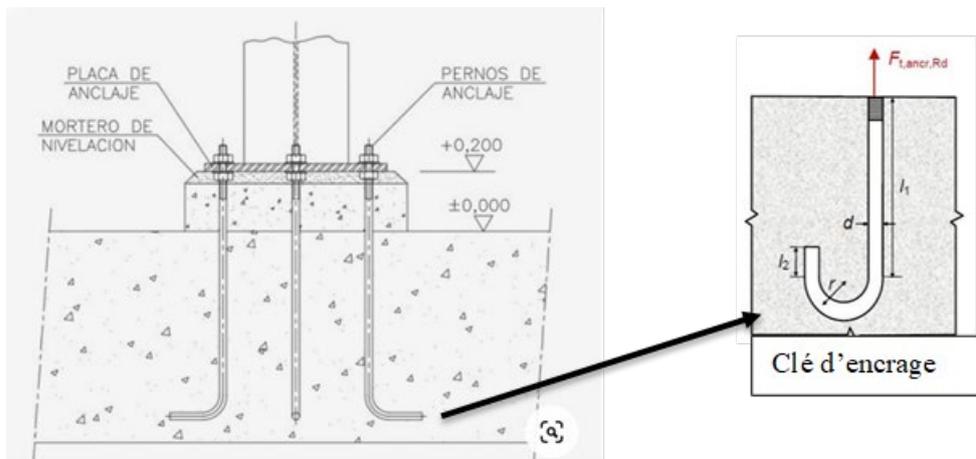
de détail de la liaison entre le poteau métallique et la semelle en béton armé⁵⁵
